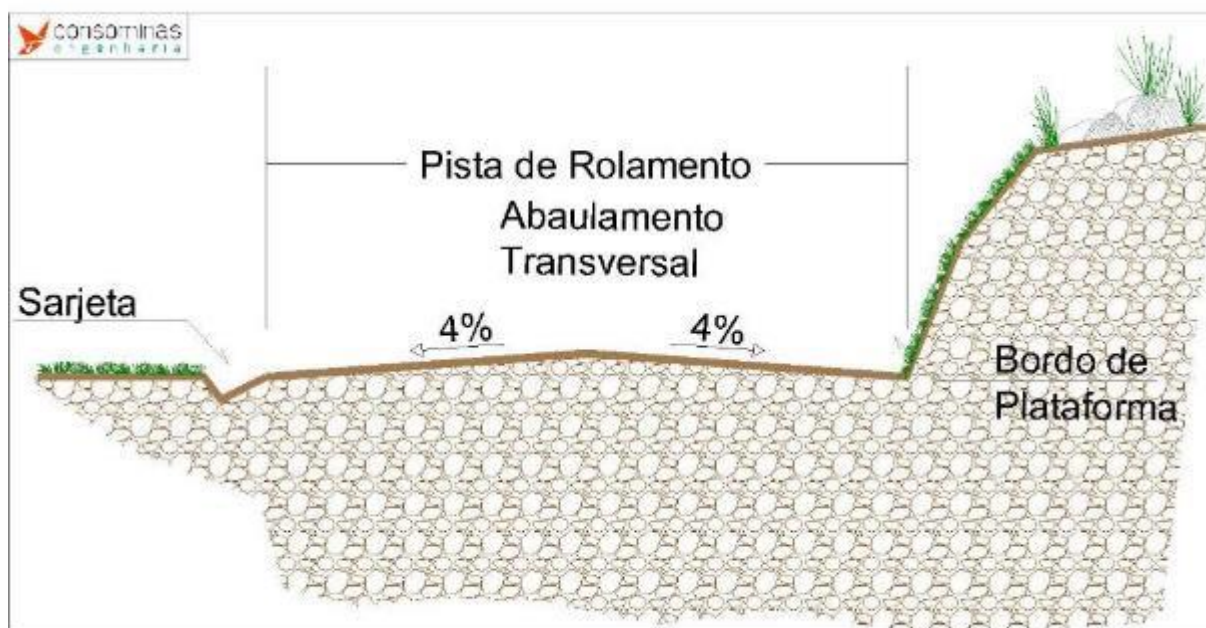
Detalhe da inclinação da seção transversal da pista de rolamento.
